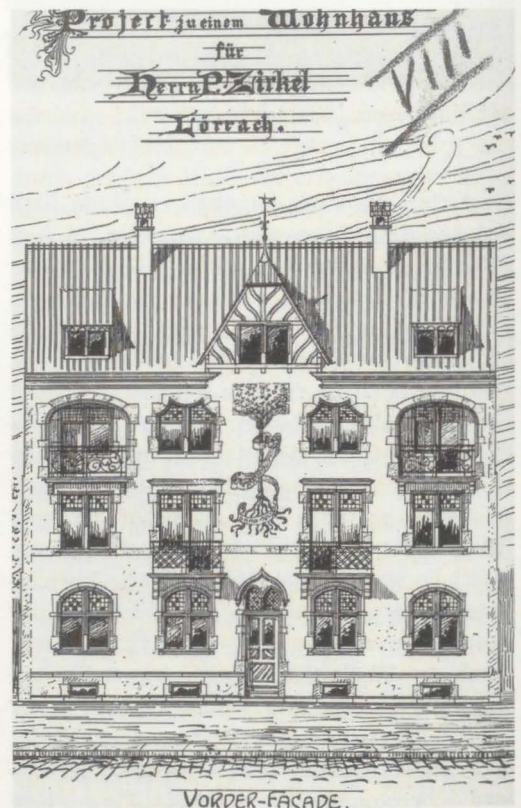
Bauplan Tumringer Str. 232, Stadtarchiv Lörrach
